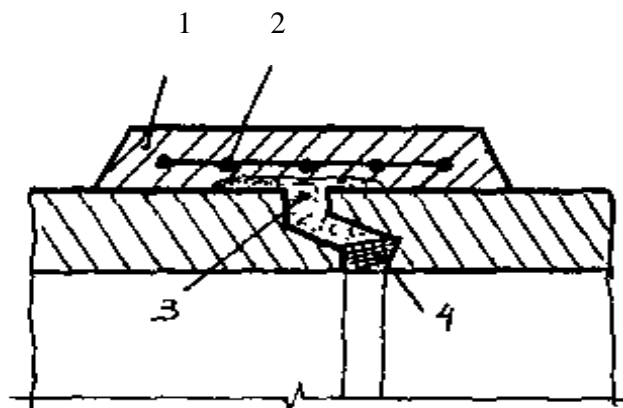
Схема фальцевого стику залізобетонних труб великого діаметра.
